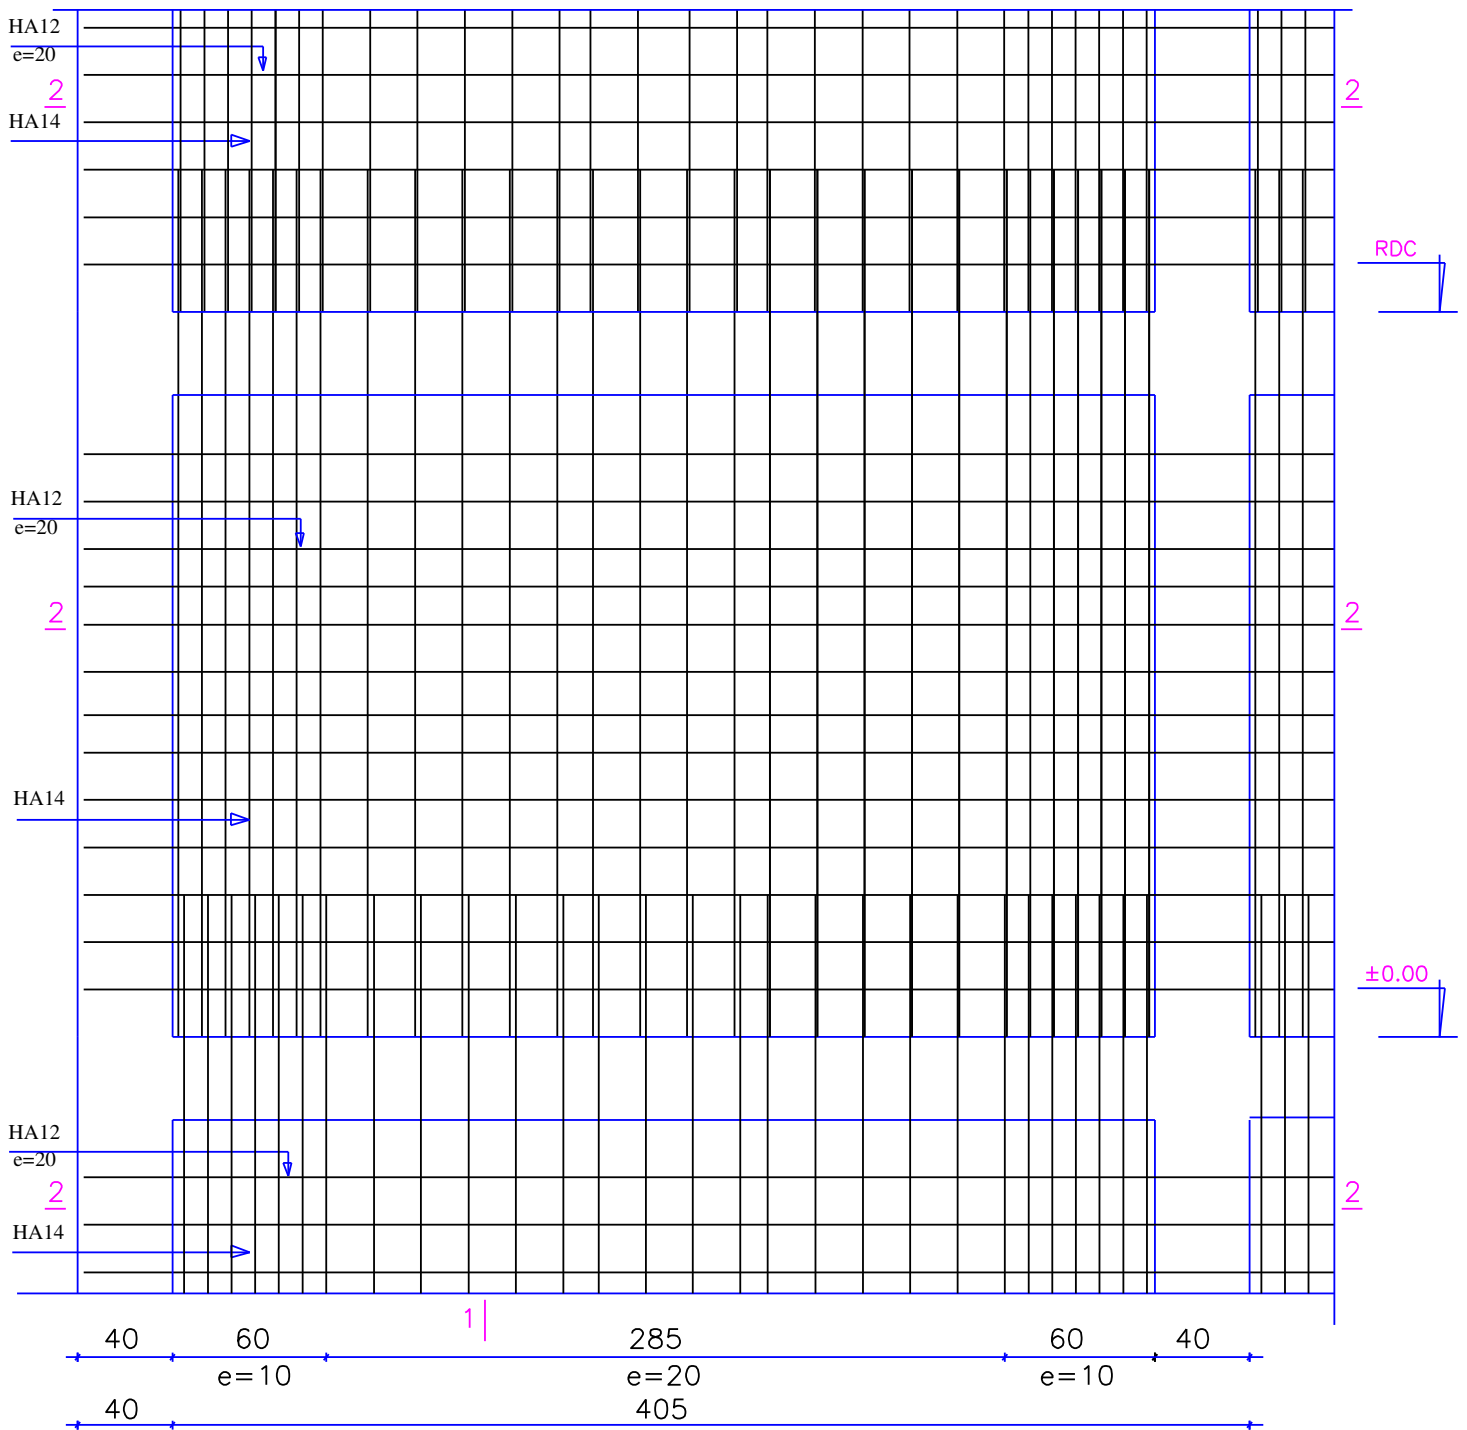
Détails d'ajout des voiles selon une coupe longitudinale
